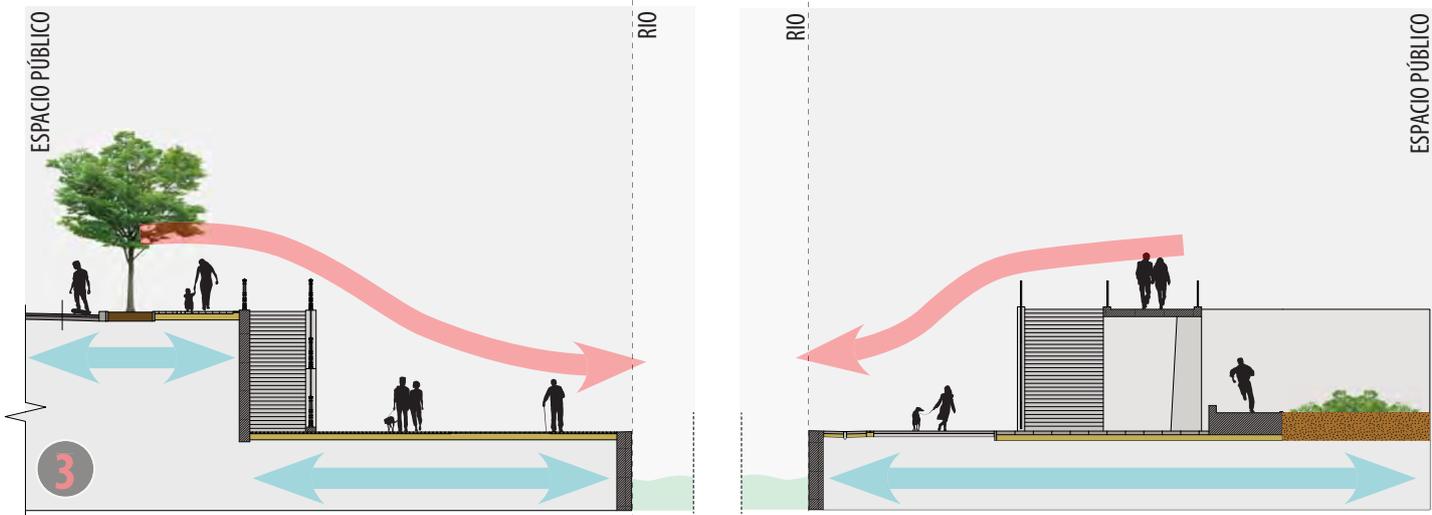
Sección tipo entre Kronprinzenbrücke - Willy-Brandt strasse
